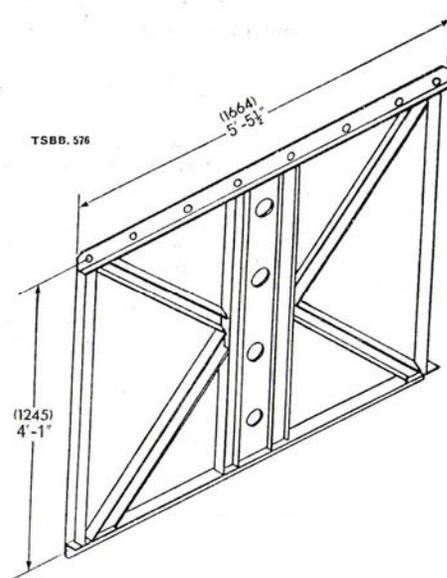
Bastidor de Arriostamiento de Viga Maestra Central (TSBB.576).
